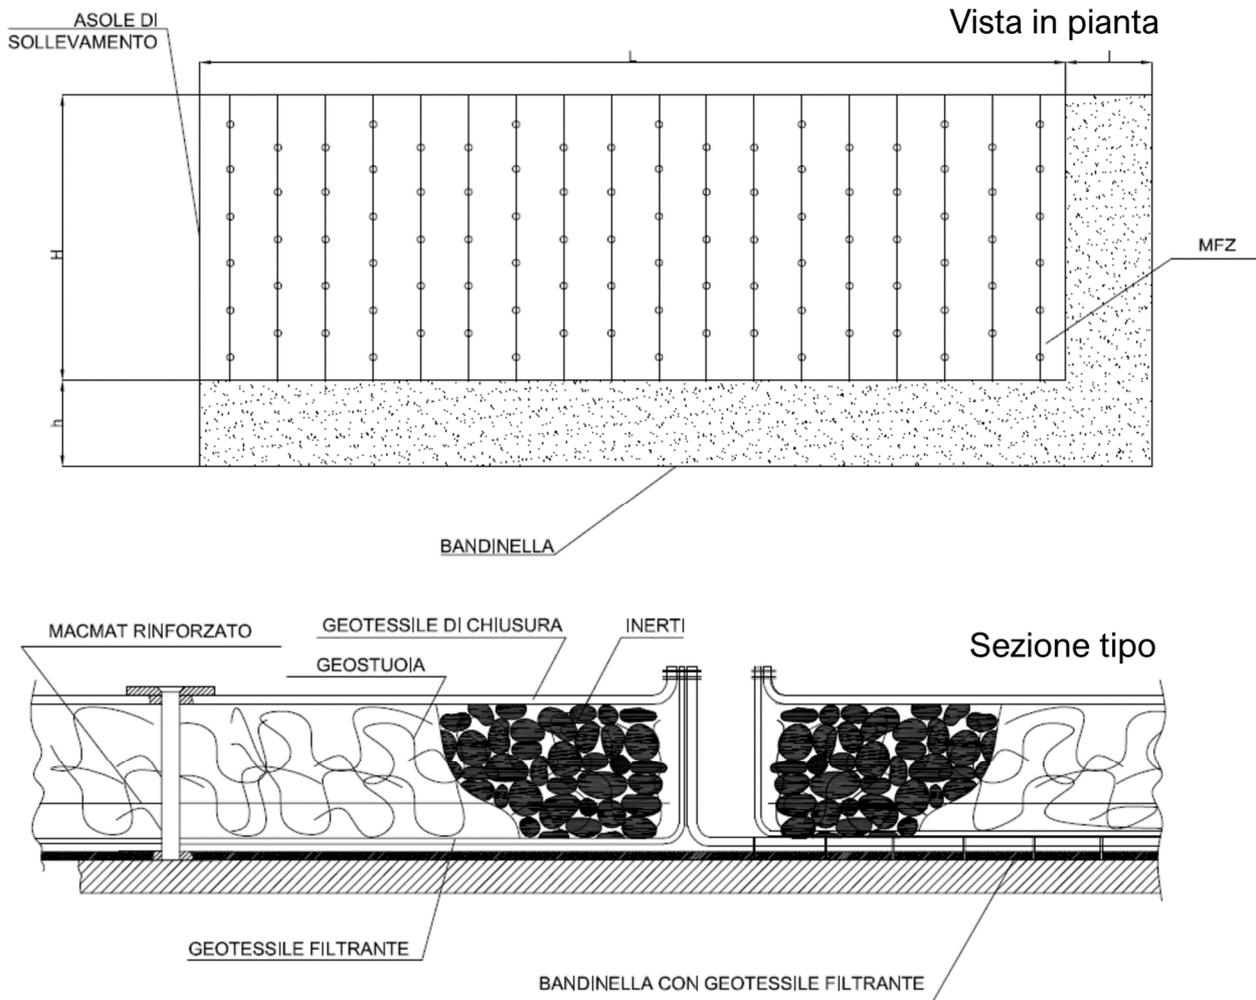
MAFZ – Vista in pianta e sezione tipo.
